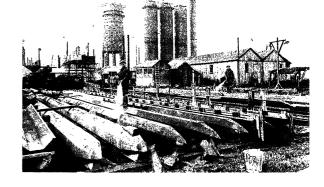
Pilotes prefabricados de hormigón esperando instalación.
